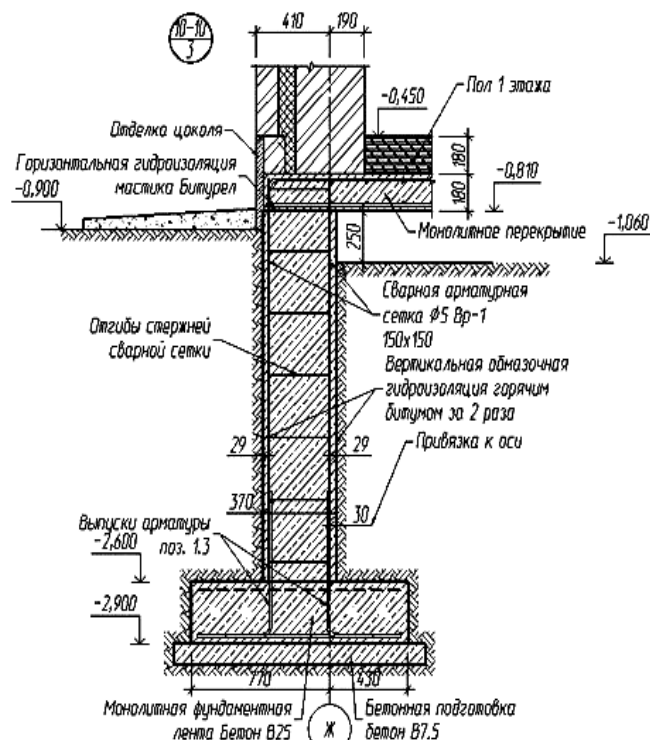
Узел монолитного ленточного фундамента под наружную стену
